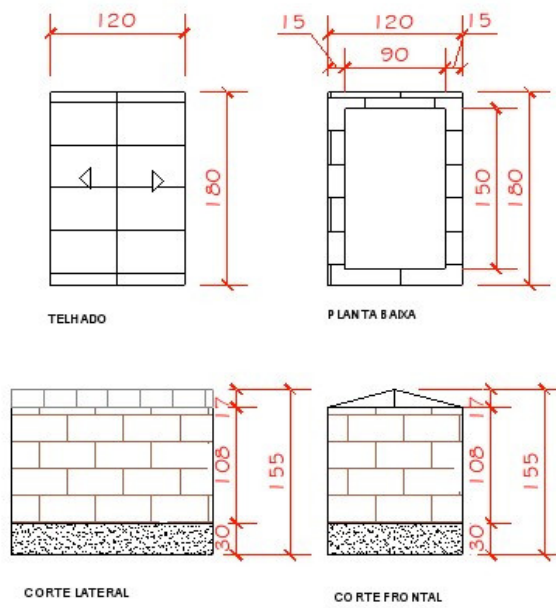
Projeto arquitetônico do modelo pot-in-pot M1 – Planta baixa e fachada (Própria, 2016).
